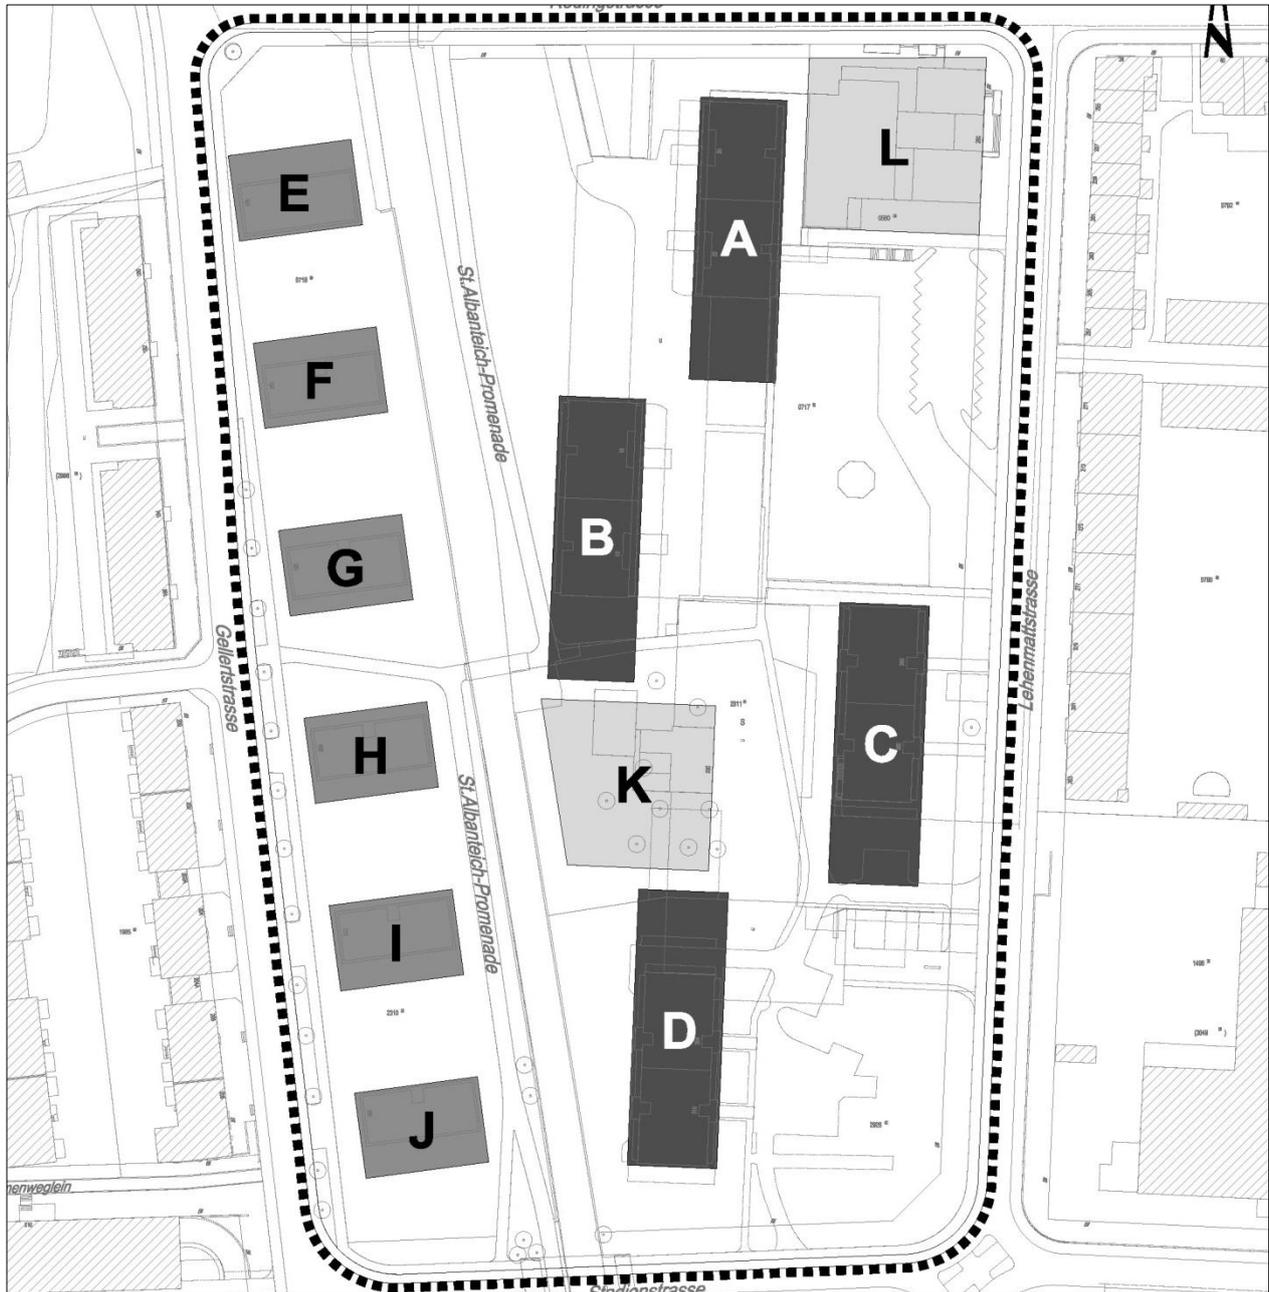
Bebauungsplan Nr. 13'861. (kein Massstab, Plan genordet)
